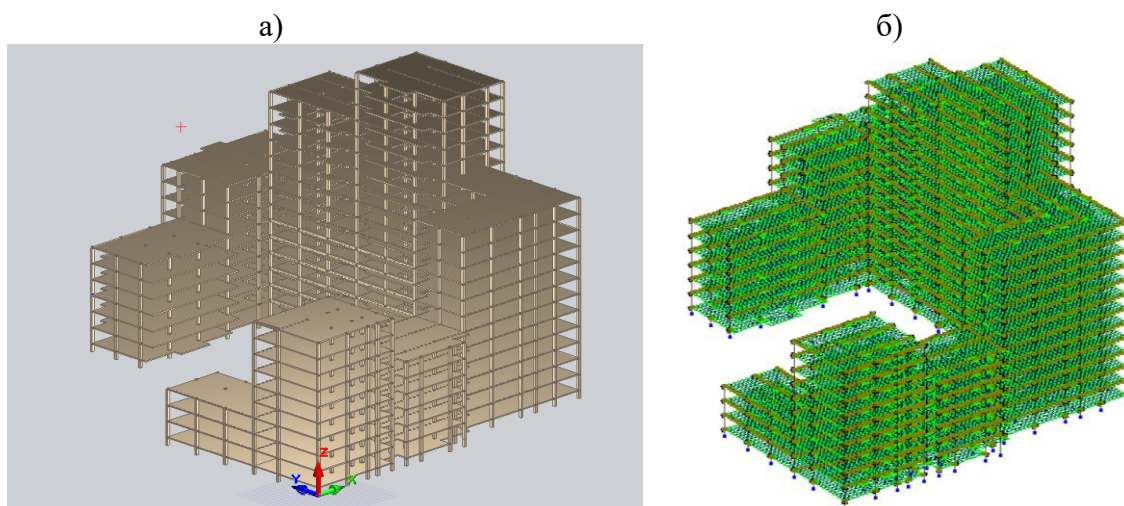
Конструктивная (а) и расчетная (б) схема каркаса здания первого уровня
